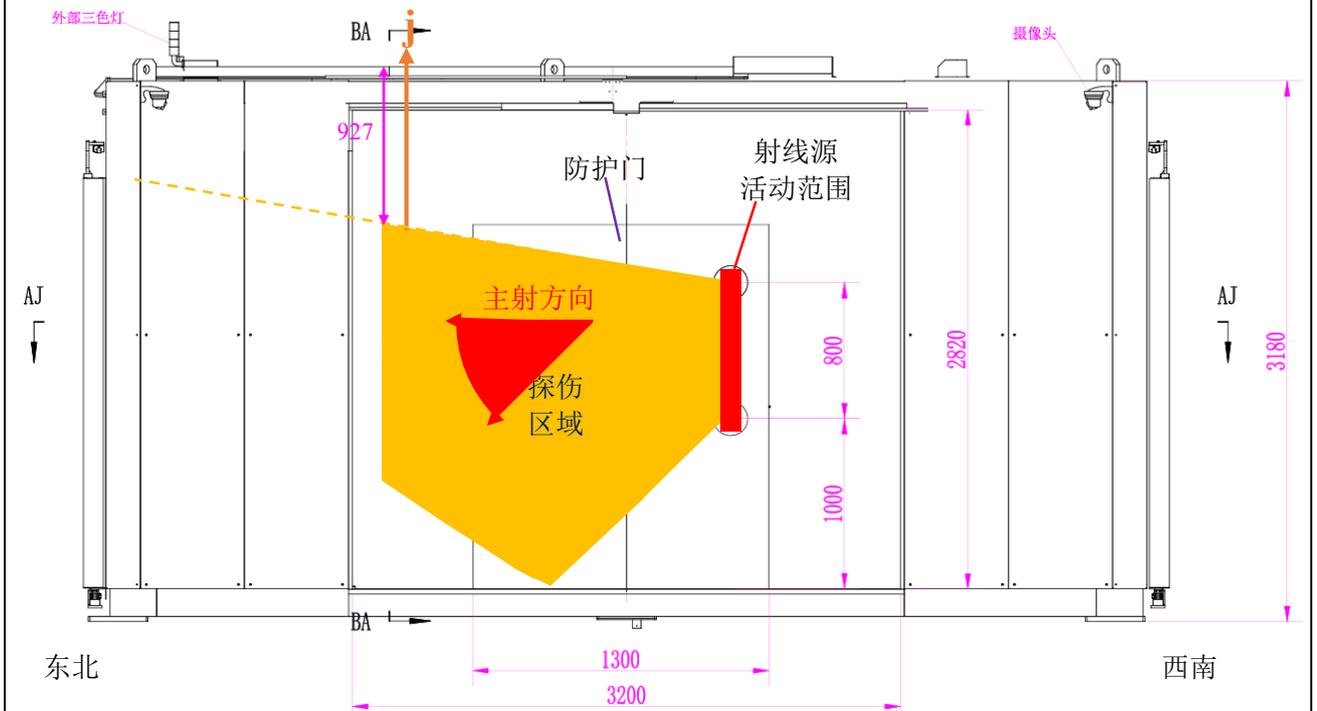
辐射屏蔽计算预测点位图 (j 点) (单位: mm)
